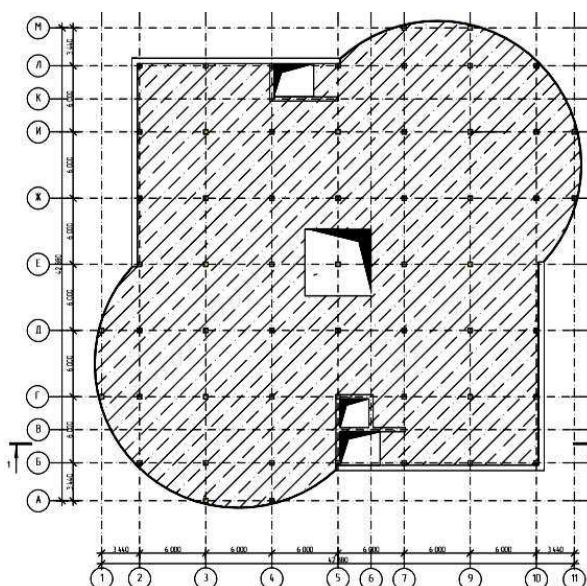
Компоновочная схема монолитного перекрытия
